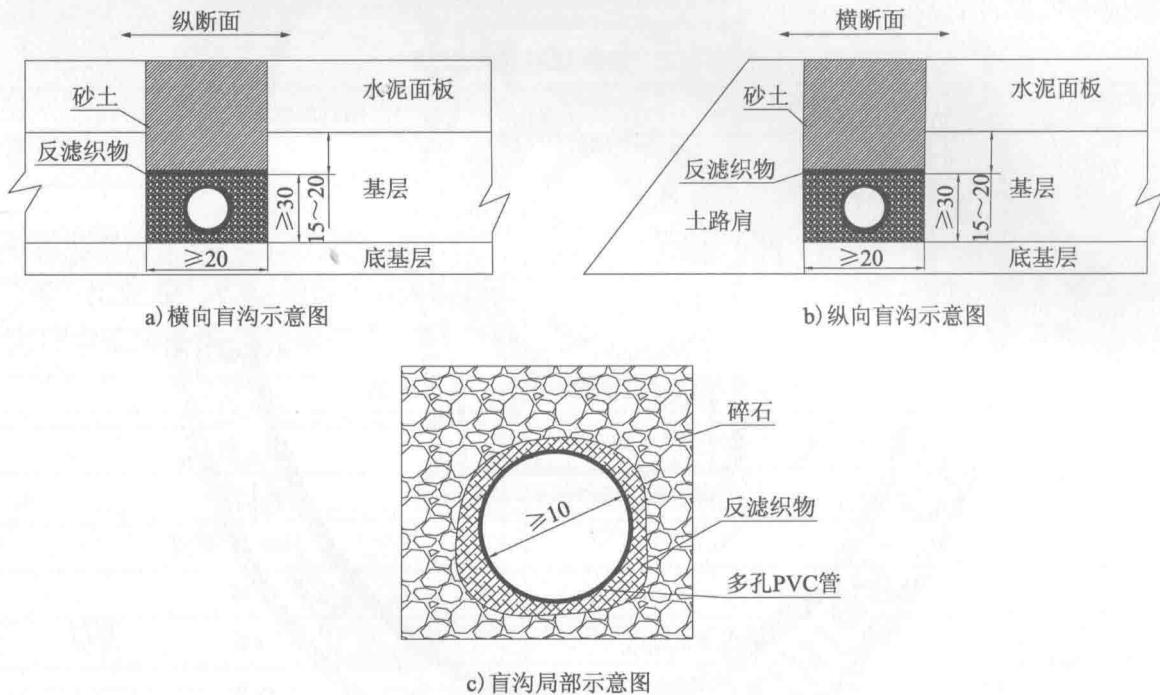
盲沟设置示意图 (尺寸单位:cm)
